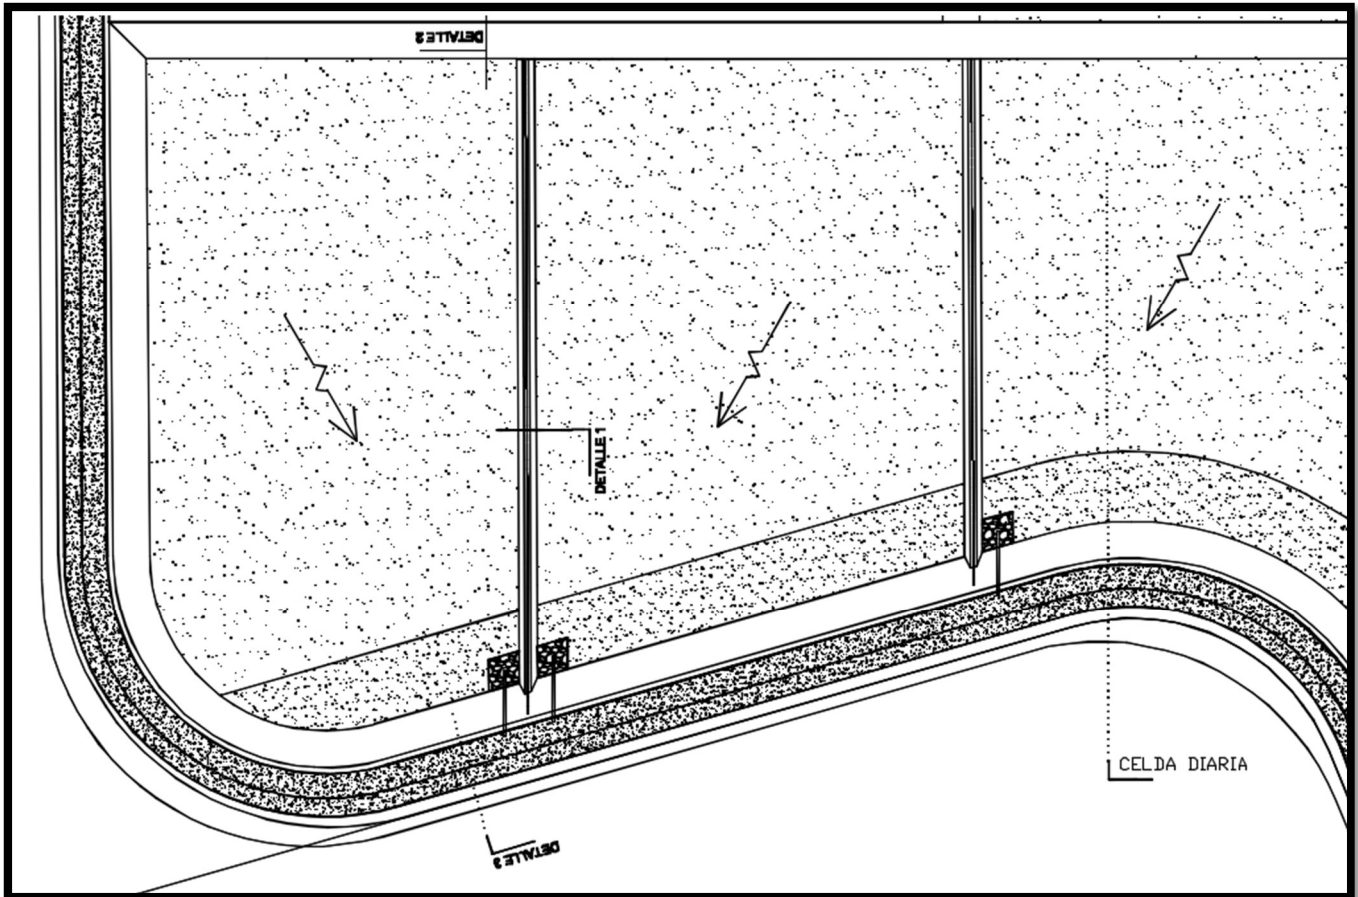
Layout Planta Celdas Diarias – Fuente: Elaboración Propia
